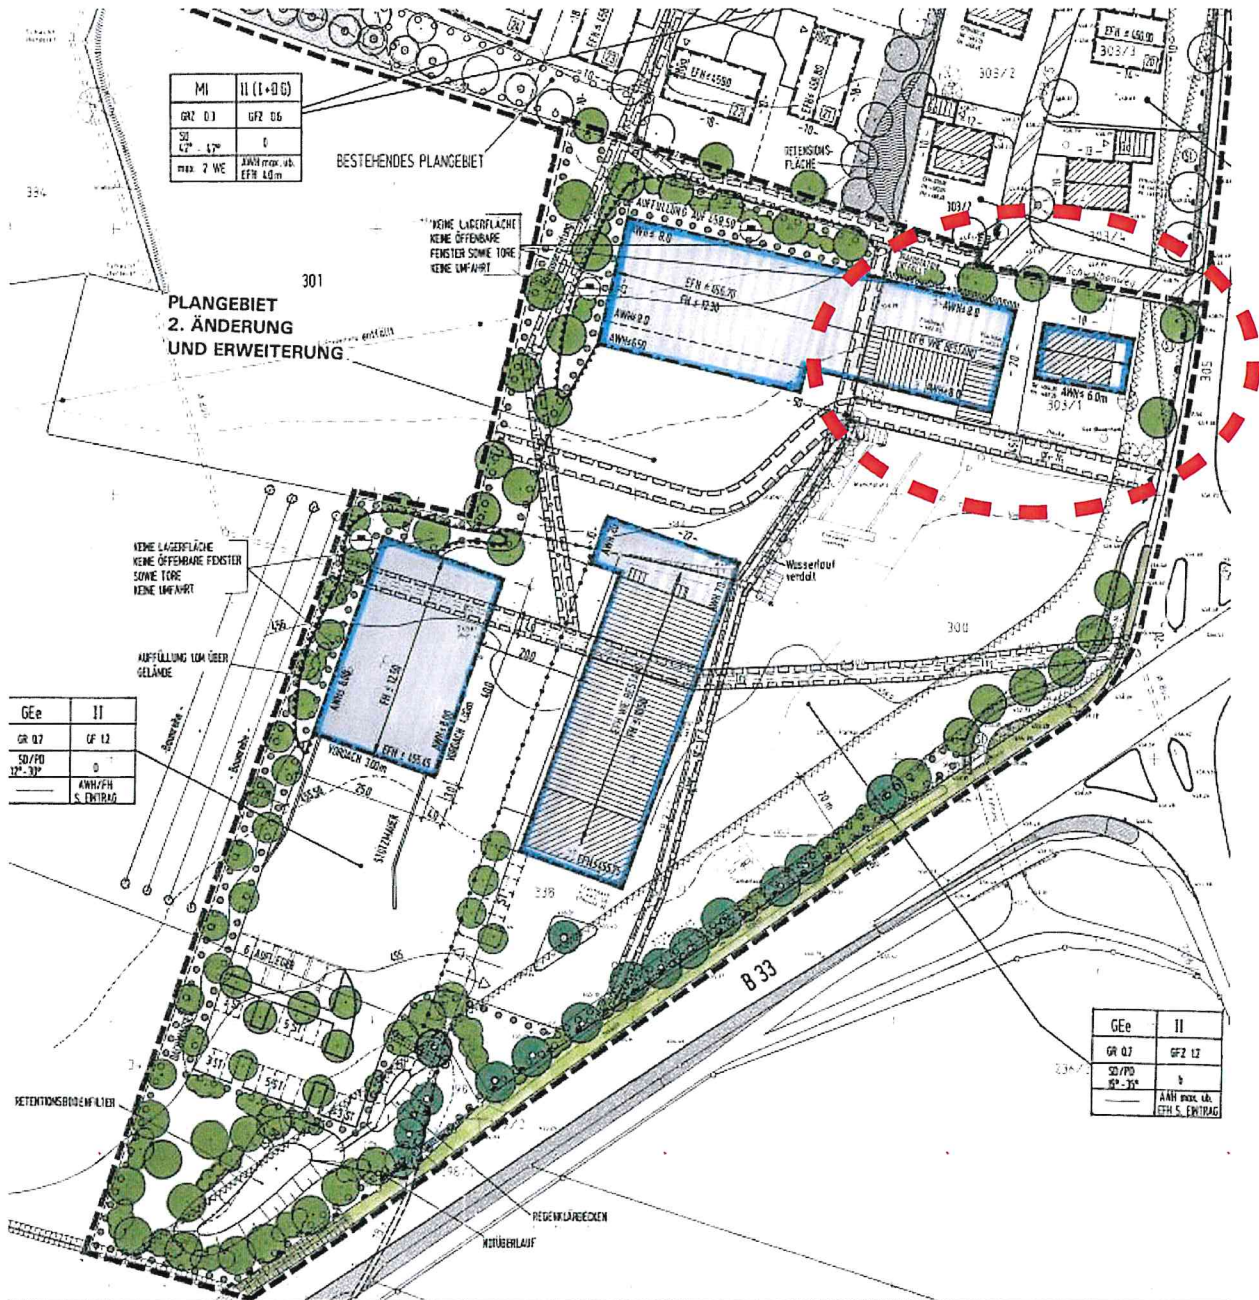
Rechtskräftiger Bebauungsplan mit Kennzeichnung Änderungsbereich (rot gestrichelt)
